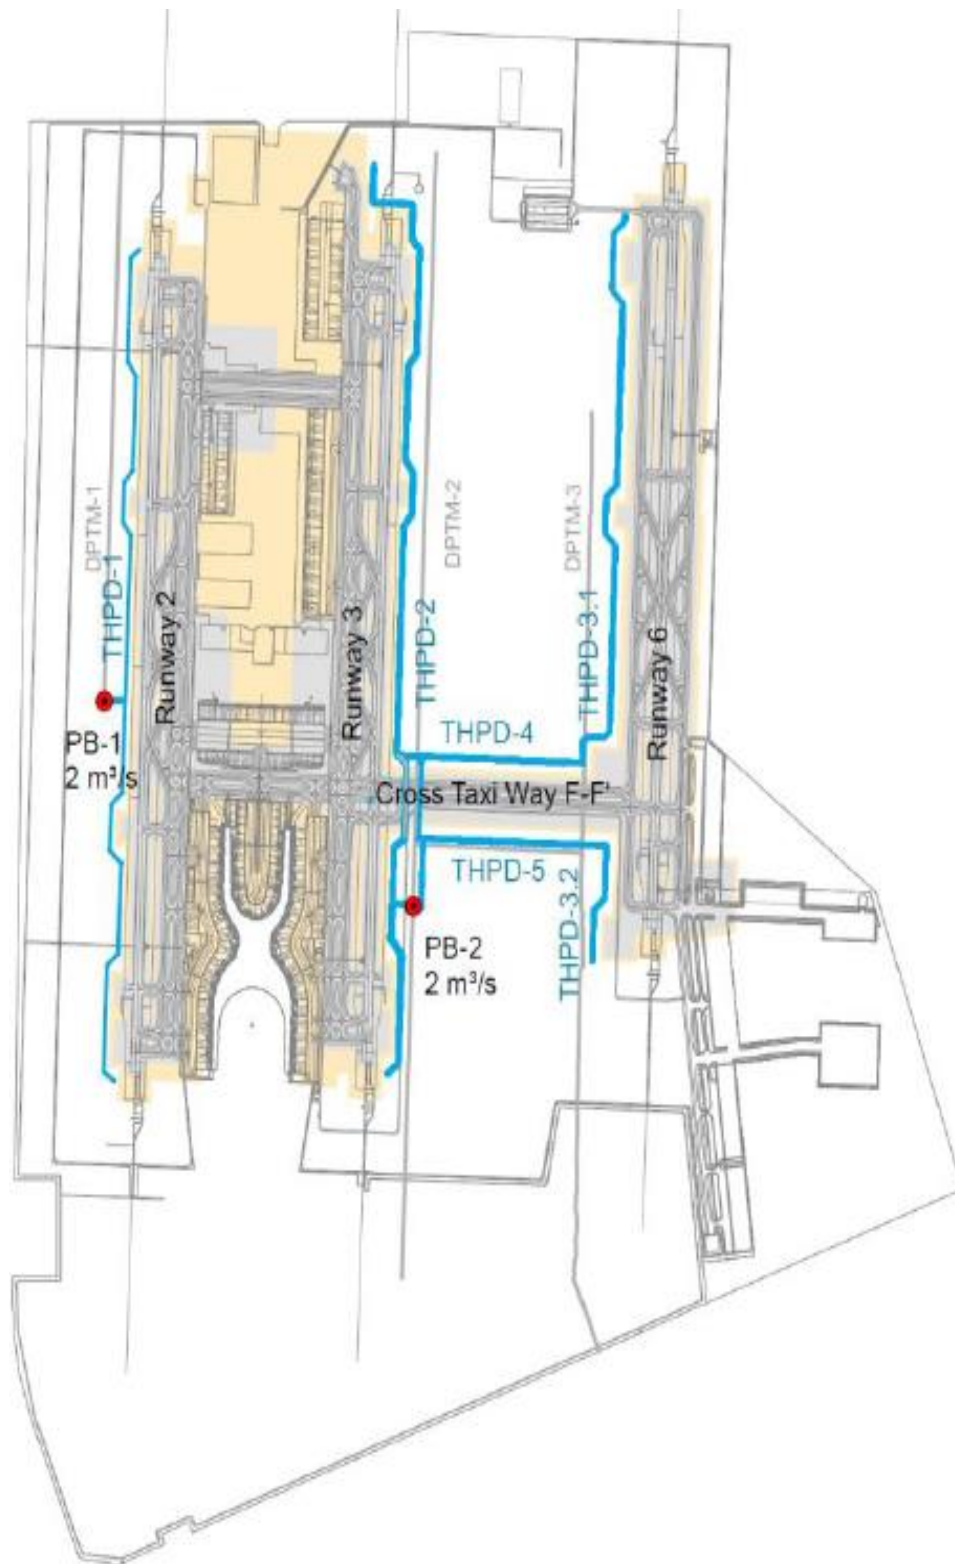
Red de Drenaje Pluvial Horizontal Precargado
